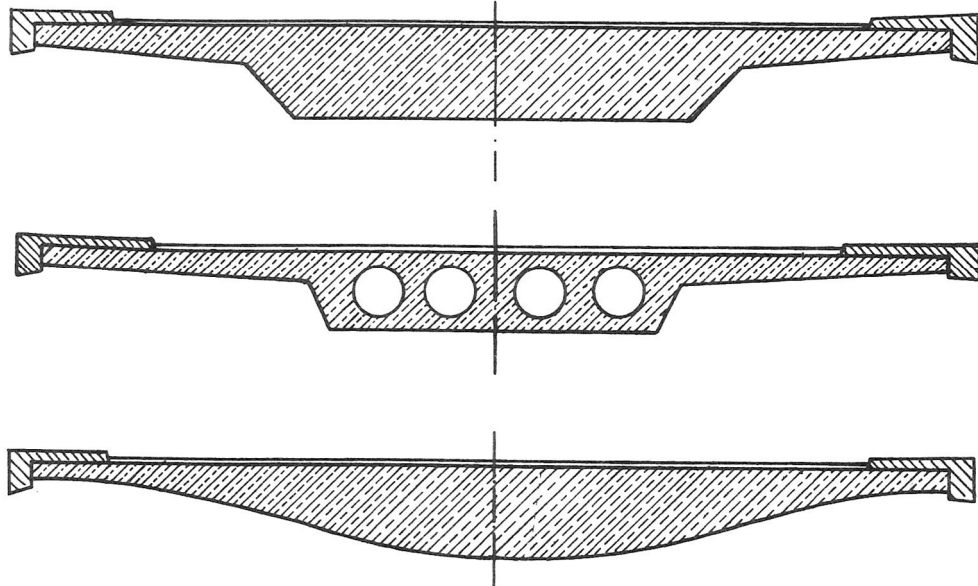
Superestrutura em laje esbelta (LEONHARDT, 1979)
